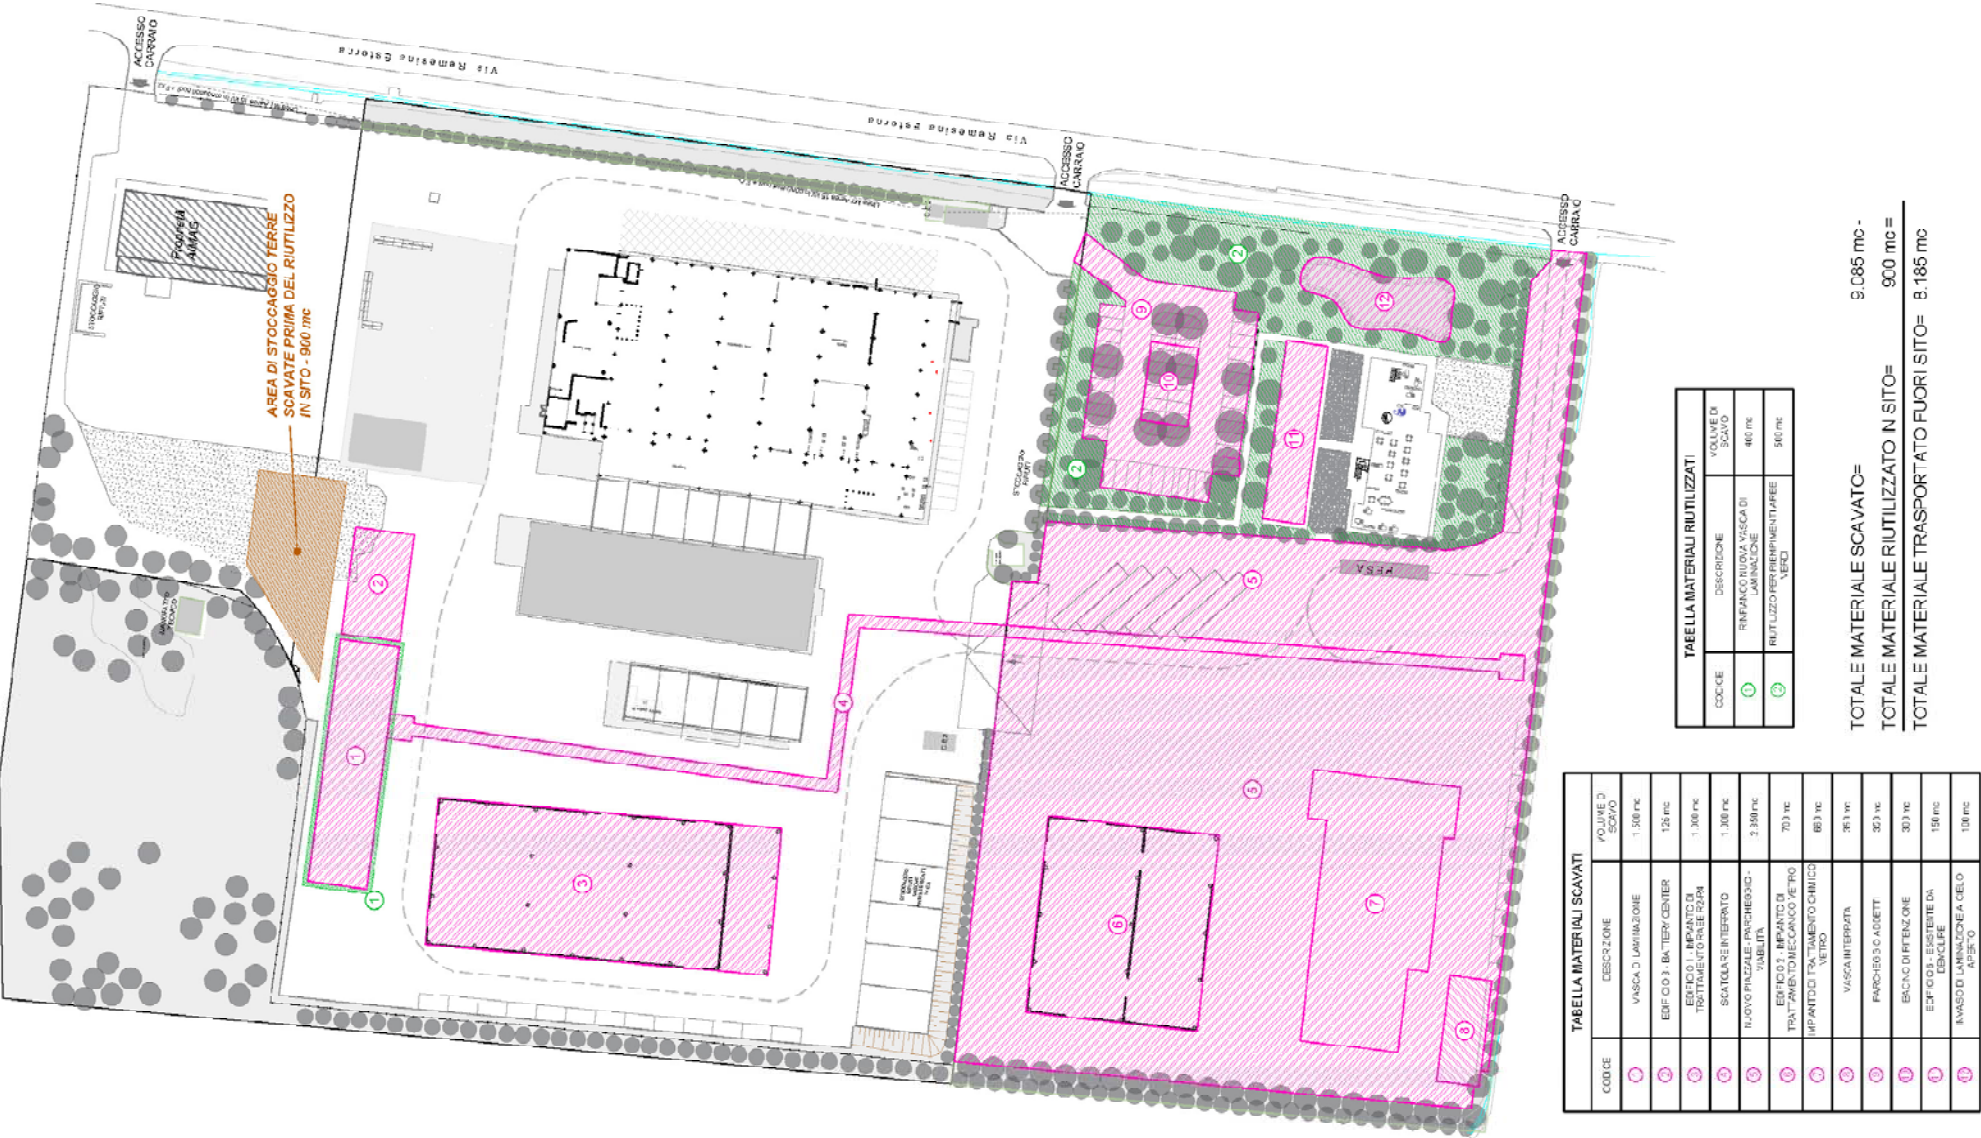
Planimetria degli scavi e riporti previsti in progetto
